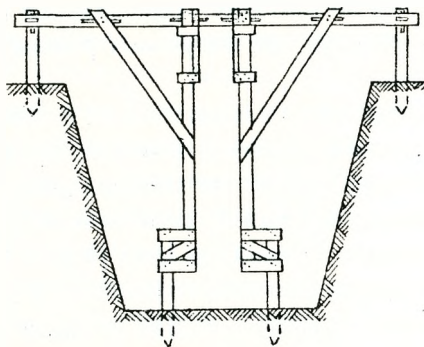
Шаблоны для бутовой кладки в траншее.
